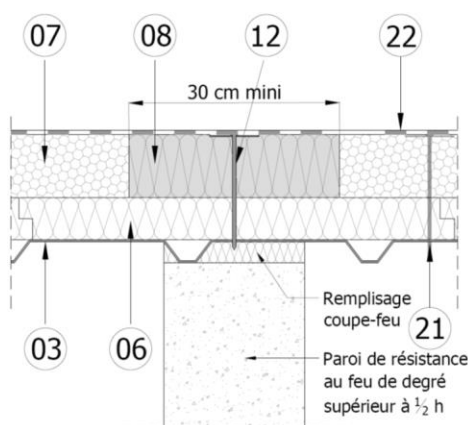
Exemple de recouvrement au droit d'une paroi verticale
